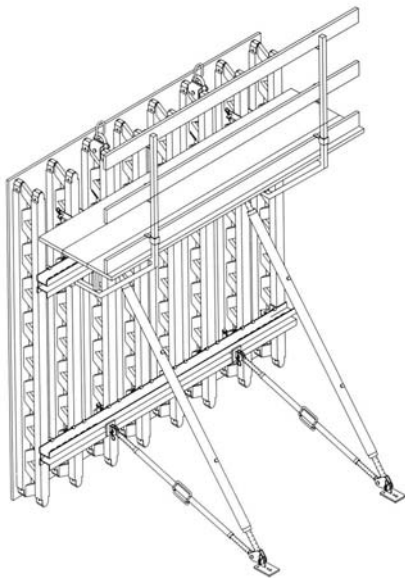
ábra. Betonozó állván. 27. ábra. Betonozó konzol 28. ábra. Betonozó konzol
